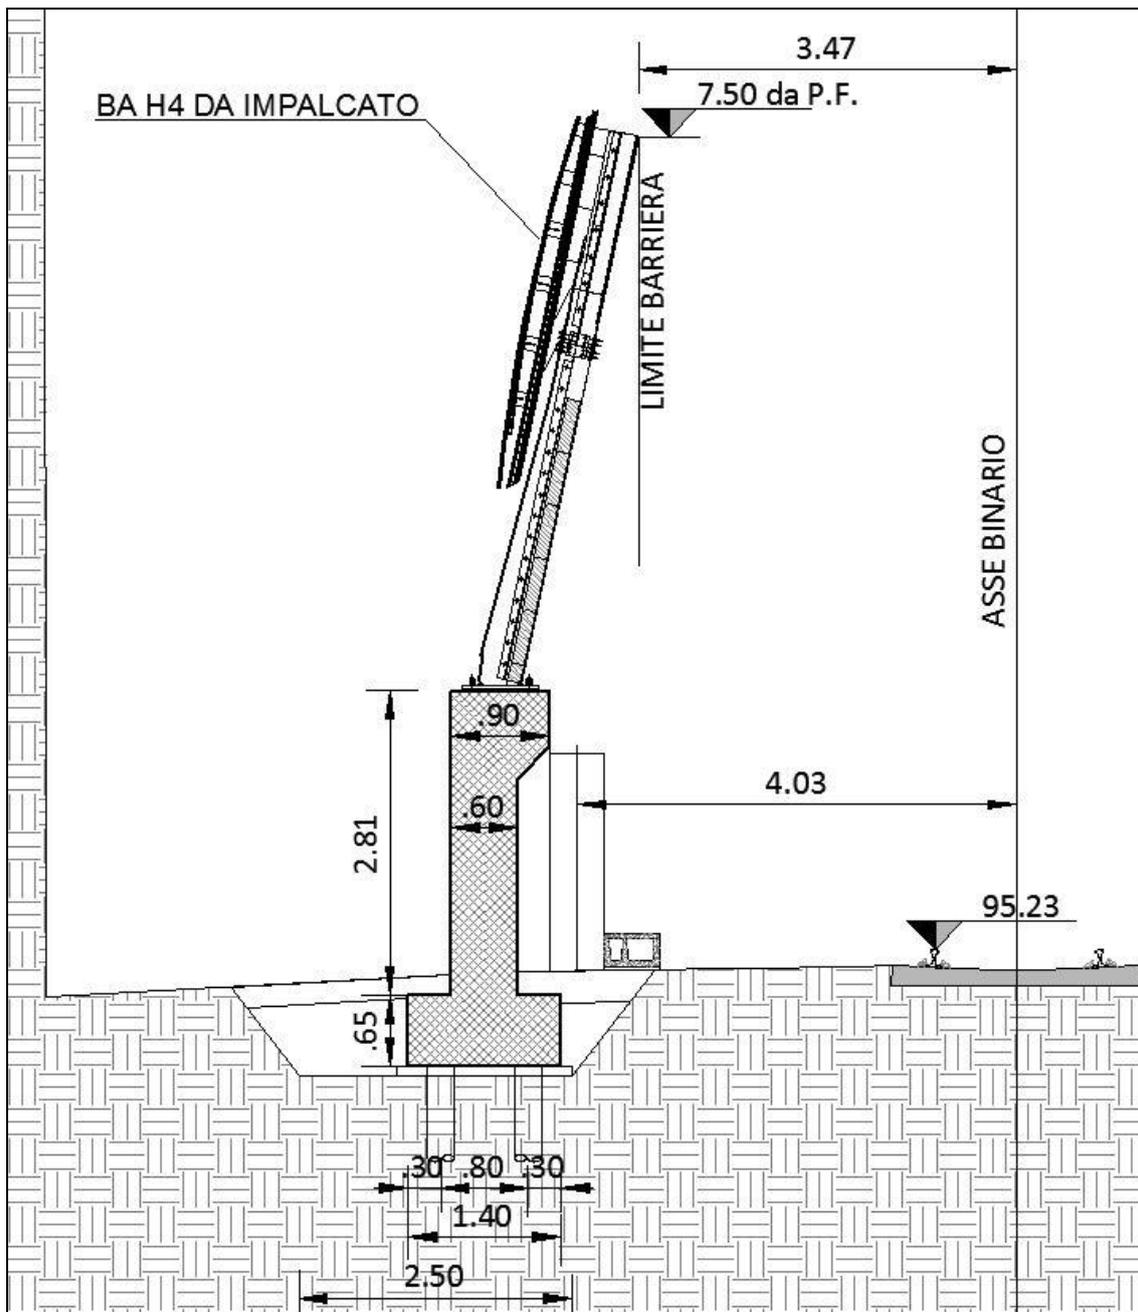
Sezione trasversale BA H4 da impalcato su muro
